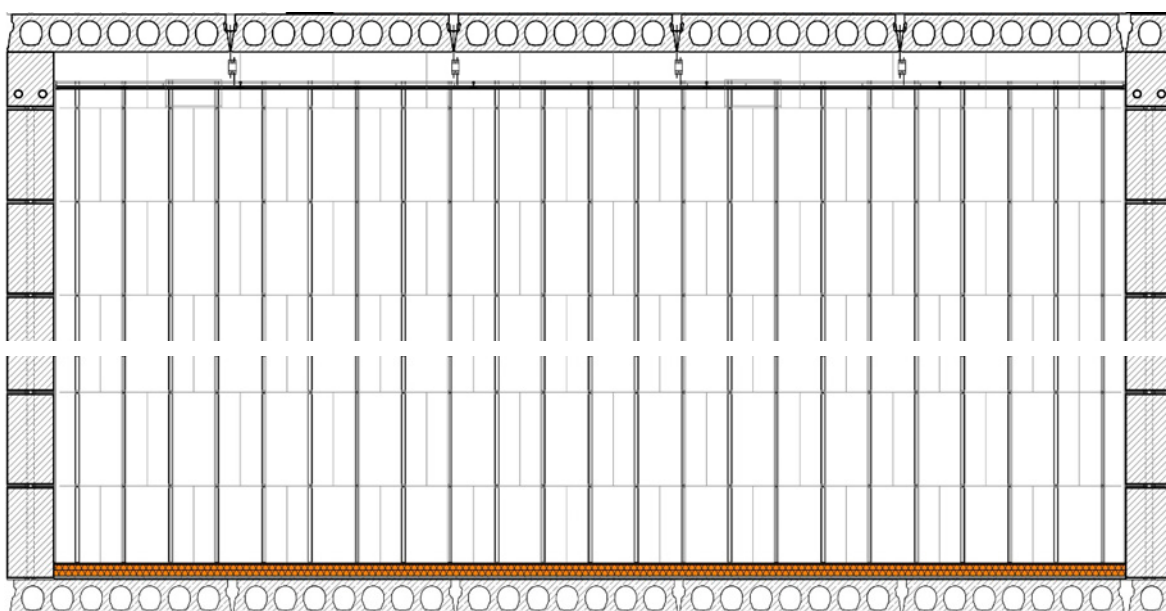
Längsschnitt-Längs- Unterkonstruktion für Wandausbau mit System MEISTER
